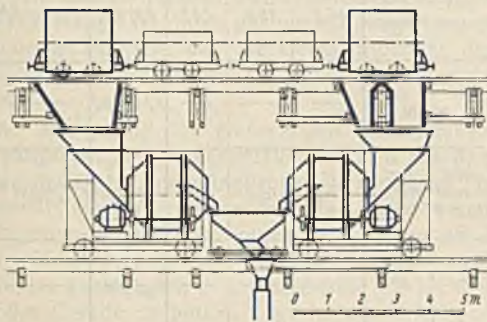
Bleilochsperre. Betonierbrücke mit Mischanlage und Materialzug.
